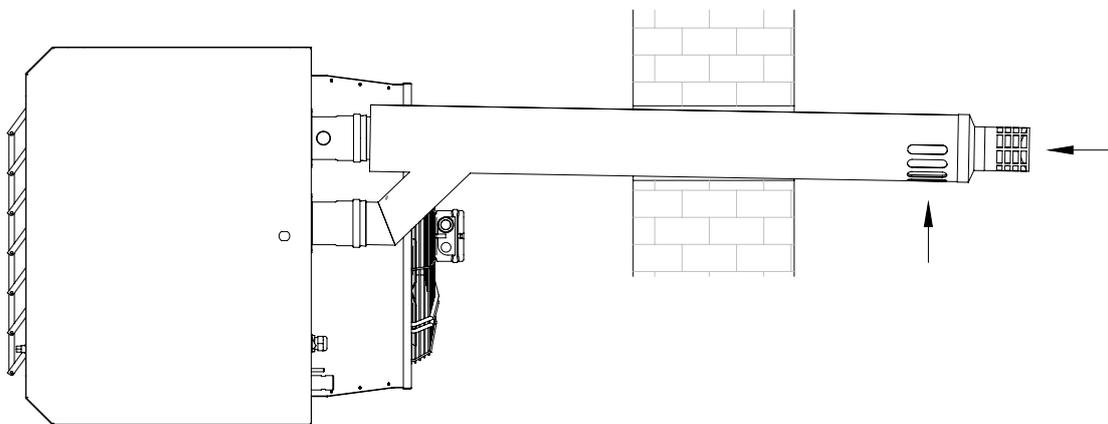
Horizontaler Einbau – Schornsteinabzug durch die Wand mit koaxialem Schornstein
